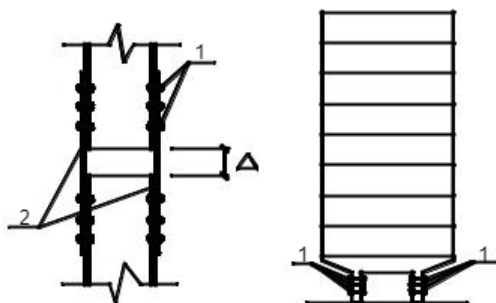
Здание с первым гибким этажом: 1 – болты; 2 – накладки
